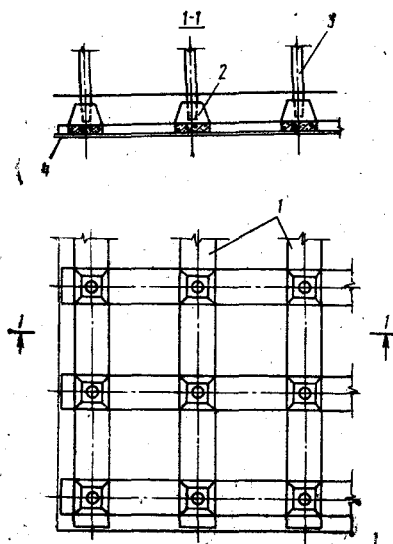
Фундамент из железобетонных перекрестных лент:
